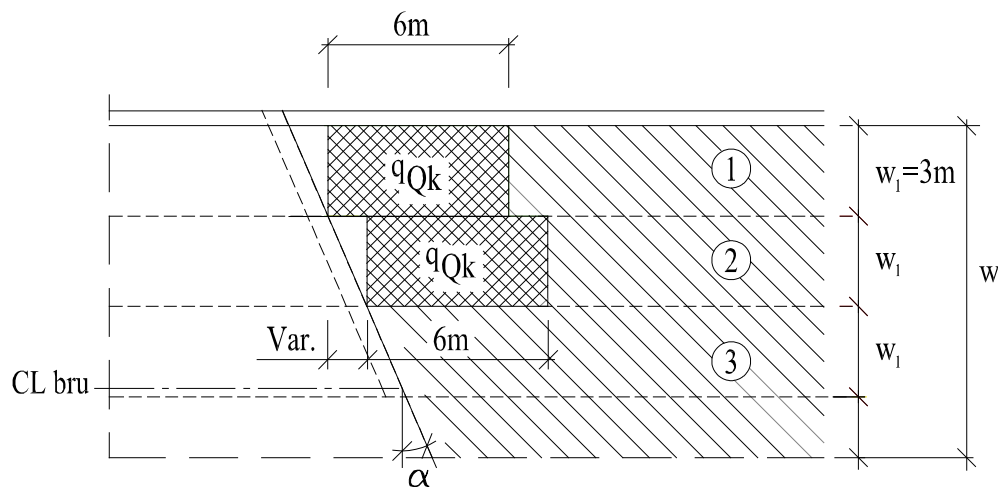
Trafikklast på vegfylling og tilhørende jordtrykk, snitt A - A
